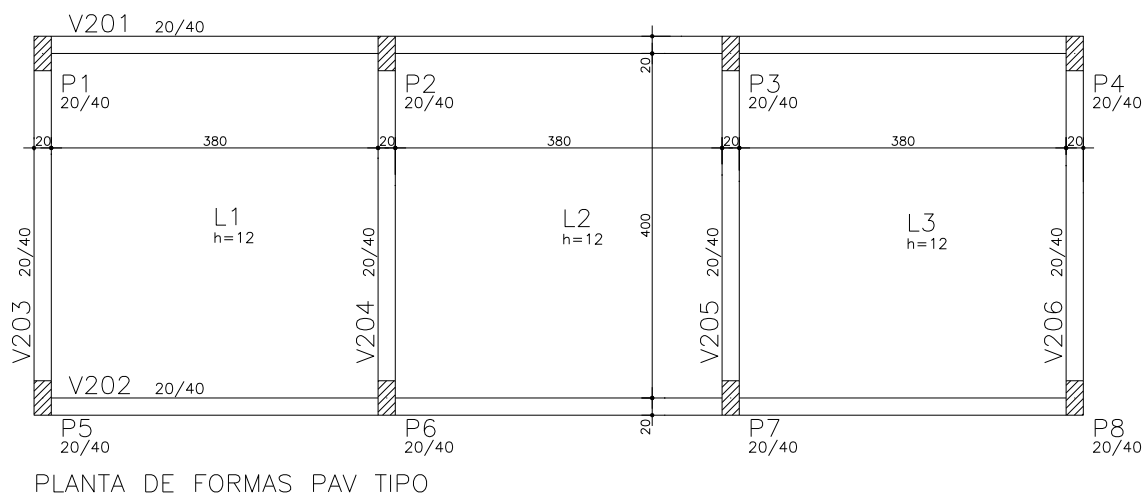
Planta de formas do pavimento tipo: T1- 3P1V1
